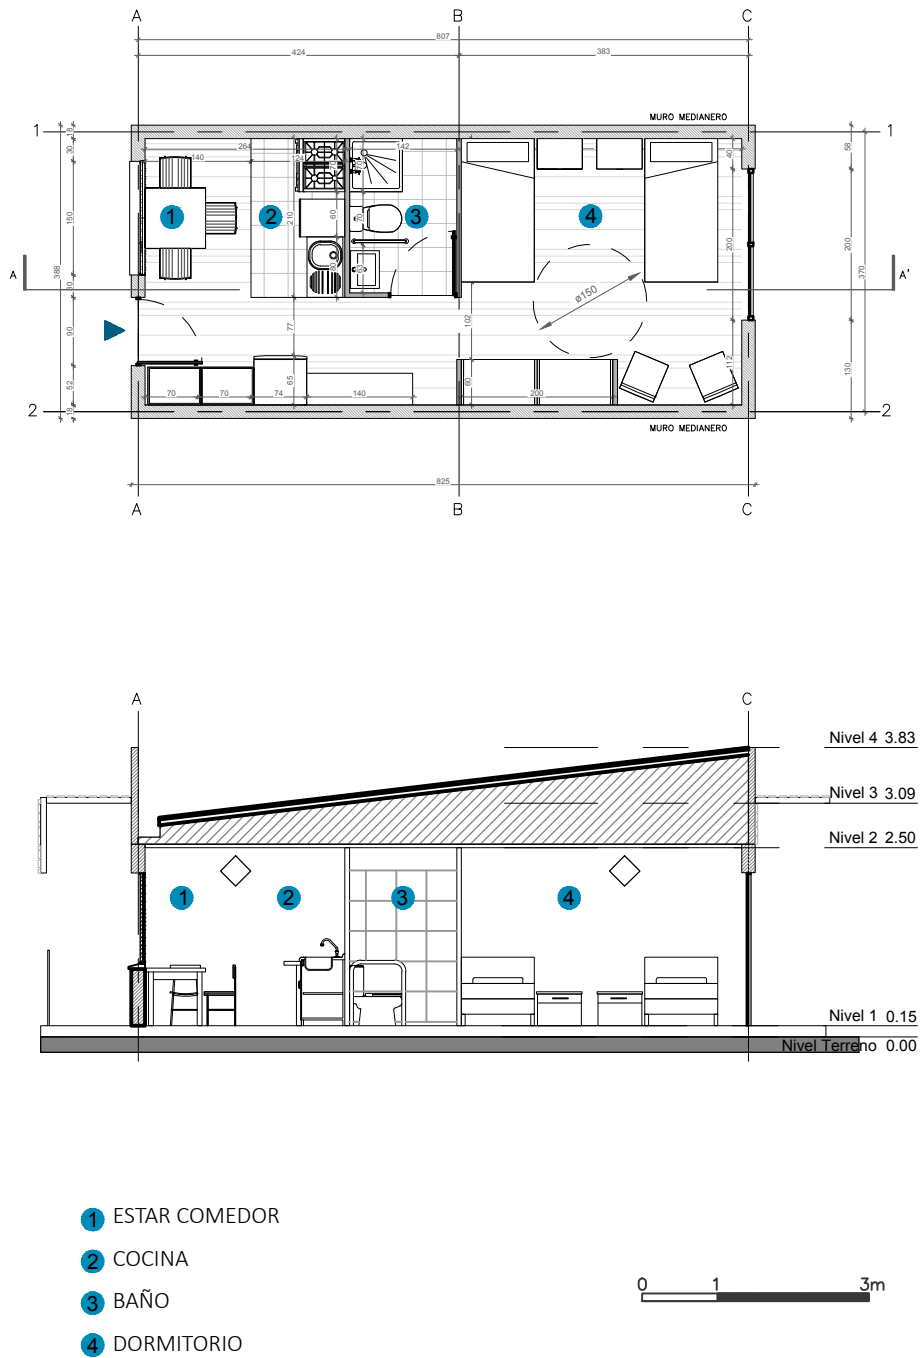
Planta y corte de una vivienda tipo CVT Iquique.
